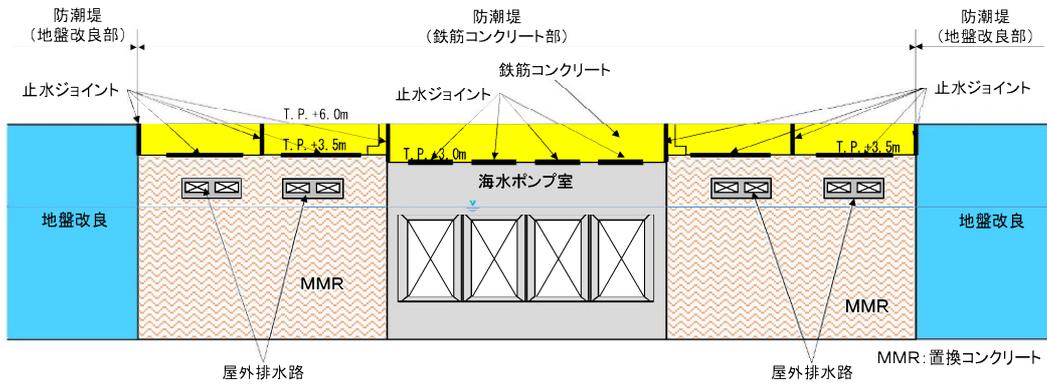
鉄筋コンクリート部 正面図 (B-B 断面)
